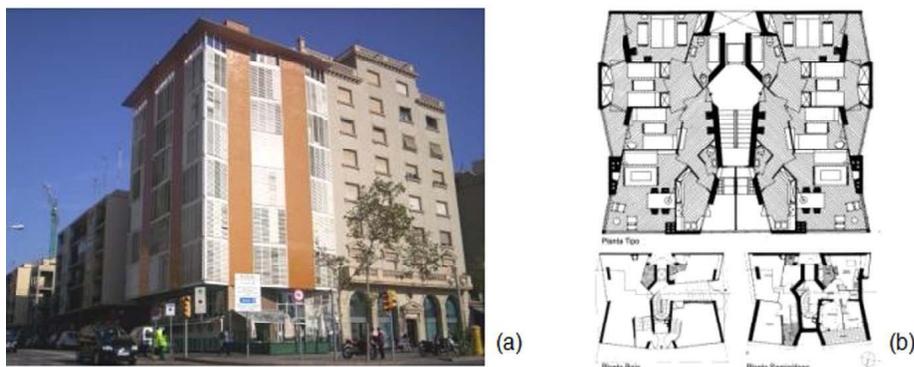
José Antonio Coderch, Bloque de viviendas para pescadores en la Barceloneta, Barcelona, (1951): (a) Vista exterior, (b) Planta tipo, planta baja y semisótano.
